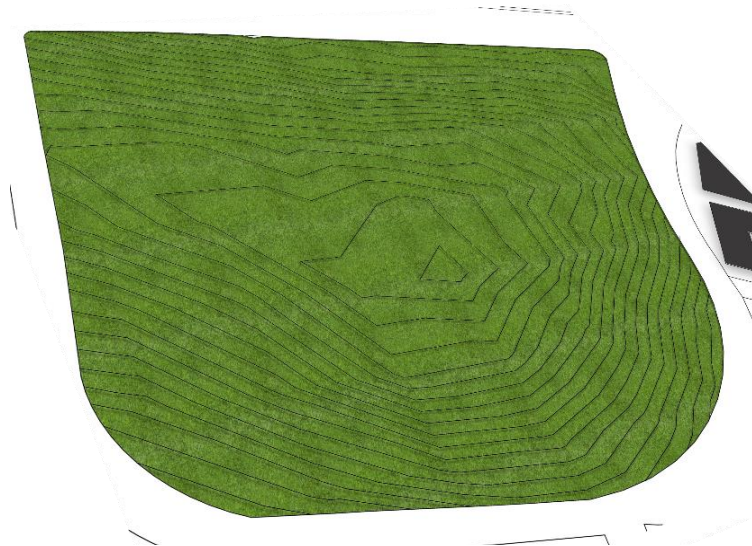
topographie de site (jardin); source: SketchUp géoposition
